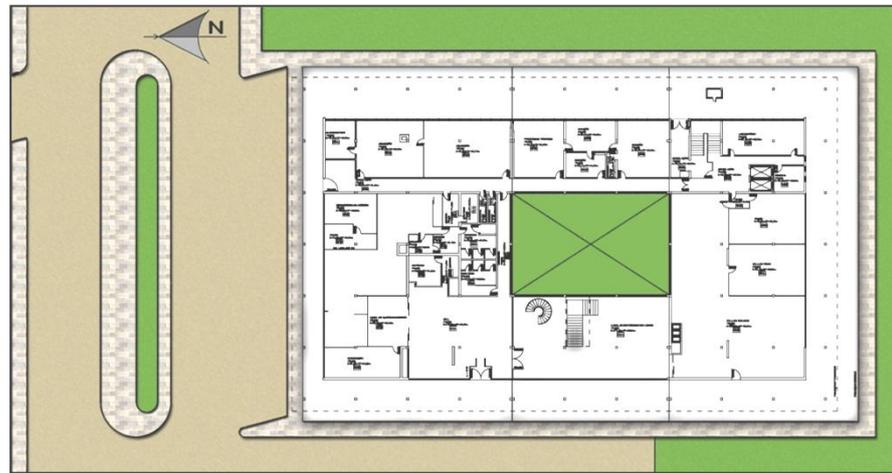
Planta da Biblioteca Central (FONTE: A Autora, 2011).
